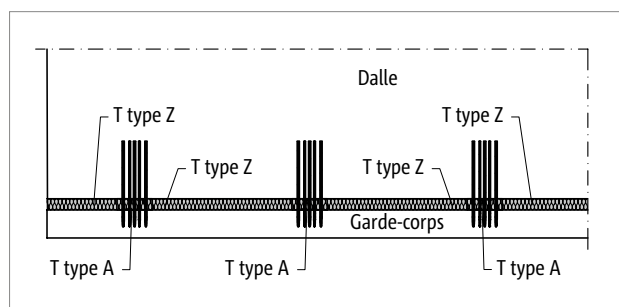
Schöck Isokorb® T type A disposition verticale : vue avec garde-corps posé au-dessus
